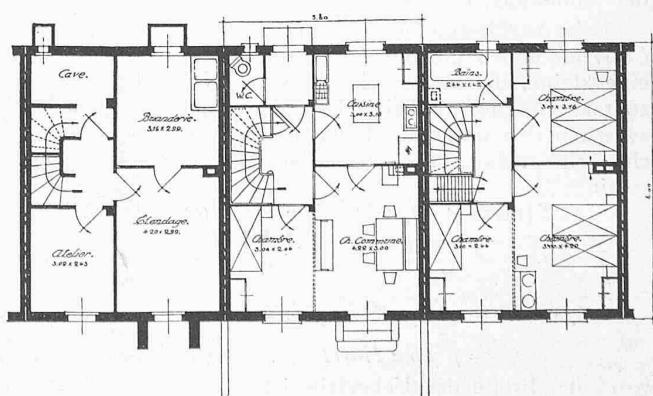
Einfamilien-Reihenhaus, Typ A. — Grundrisse 1:200.
